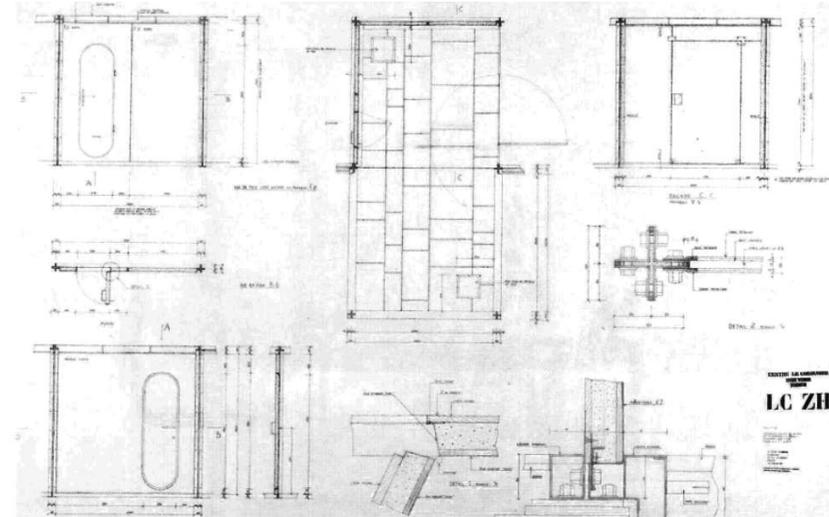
Detalles constructivos de las dierentes puertas. plano nº 159, 9 de agosto 1966.
